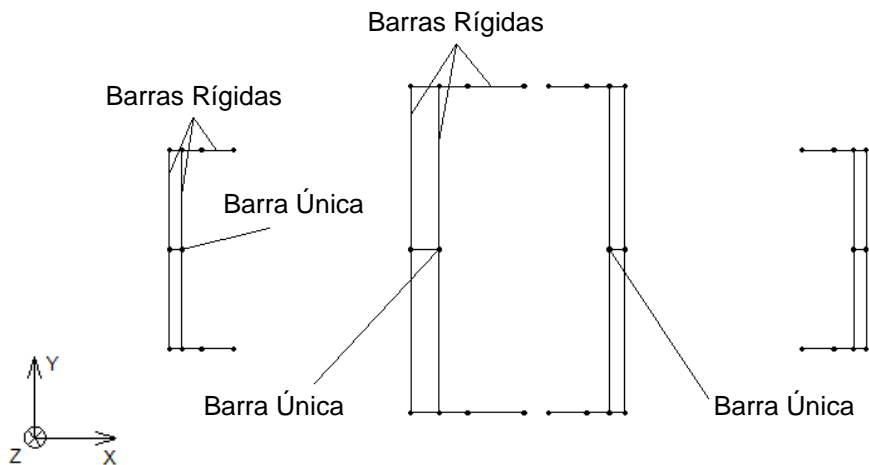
Vista em planta, até ao 37º piso, do núcleo central com aberturas e dos laterais
